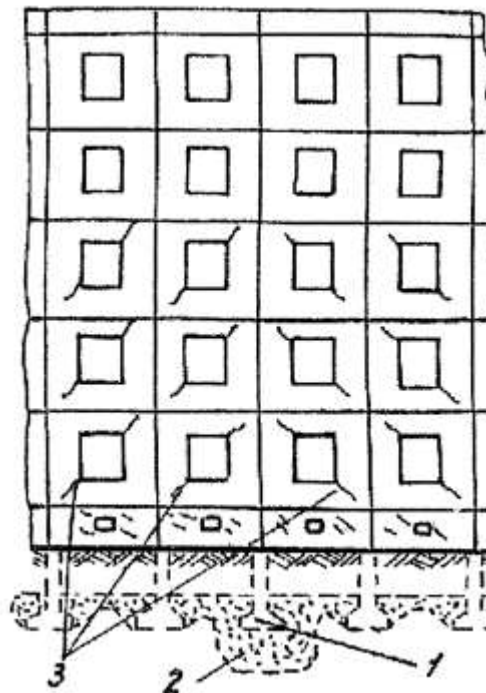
Схема трещин в стене крупнопанельного здания от неравномерной осадки фундаментов: 1 - поперечный фундамент, давший осадку большую, чем примыкающие фундаменты; 2 - насыпной грунт;
